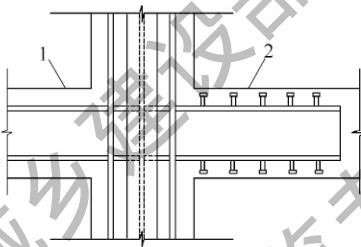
框架柱一侧为型钢混凝土梁，另一侧为钢筋混凝土梁的连接
